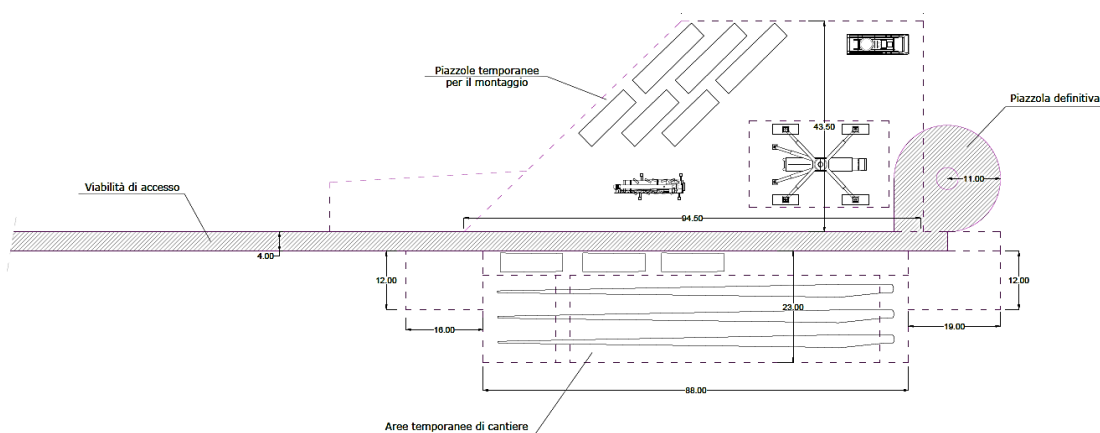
Planimetria piazzola temporanea per montaggio ed aree di lavoro
